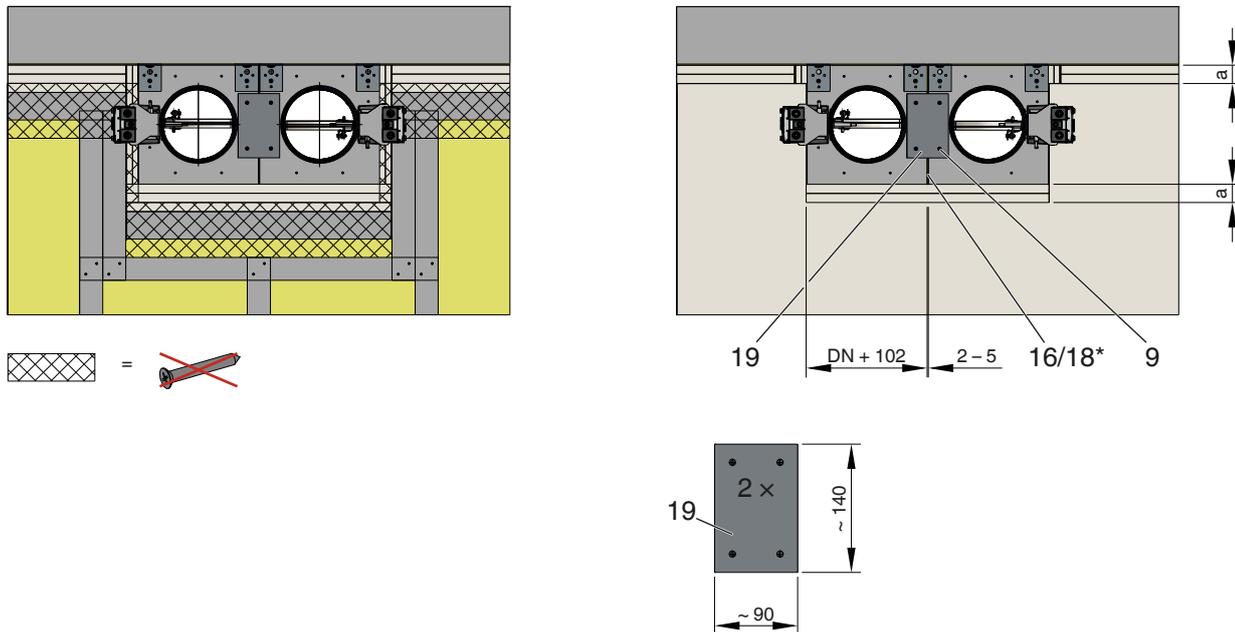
Wandbeplankung und Verschraubung – Abstand zweier Einbausätze 2 – 5 mm zueinander
